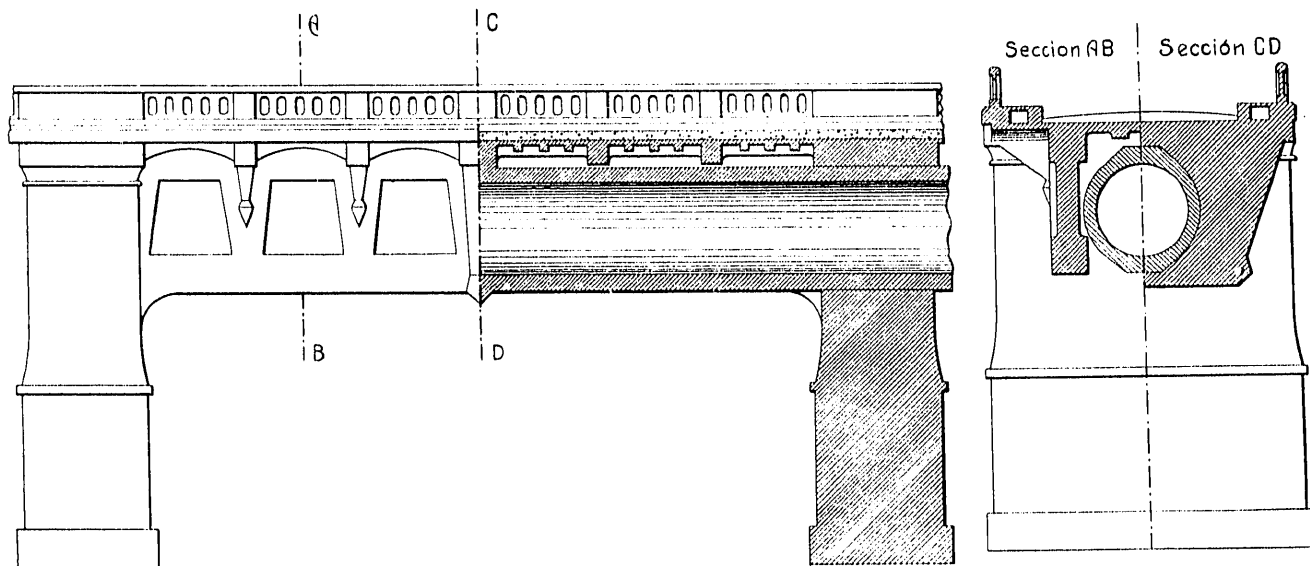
ª: Puente proyectado. Detalles de un tramo.
